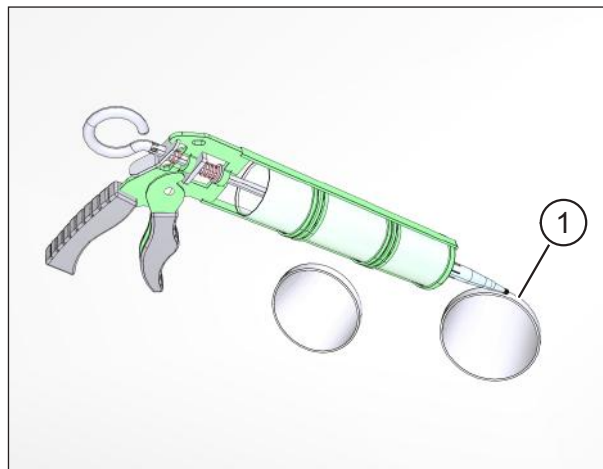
герметизировать вентиляционные трубы на наружной стене
